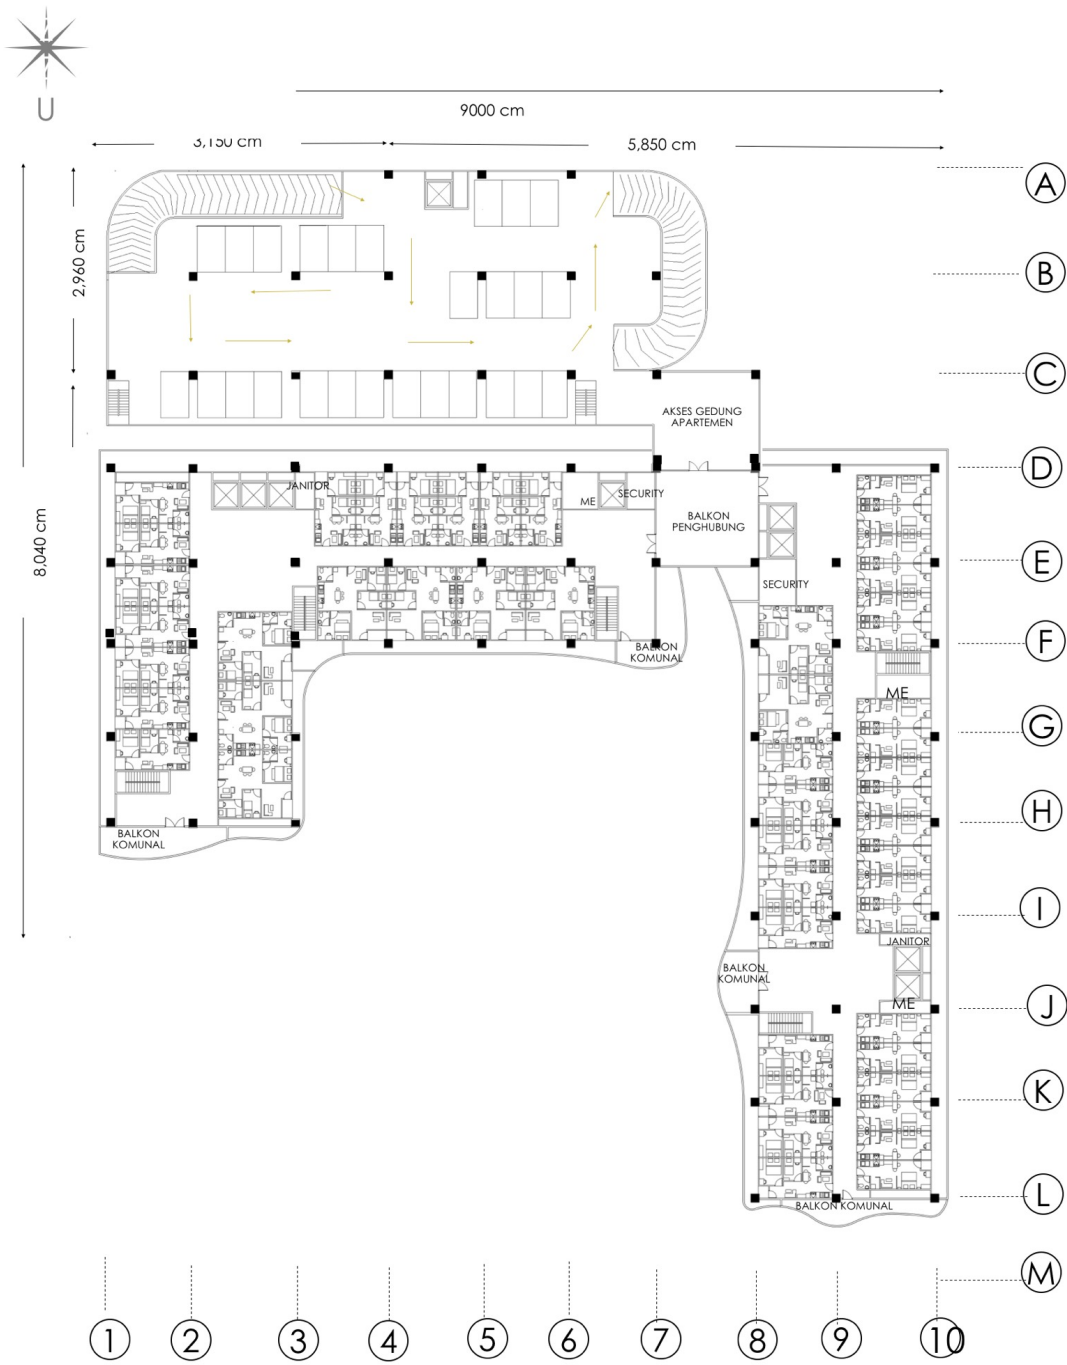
Mezzanine Floor Level 3 dan 4
